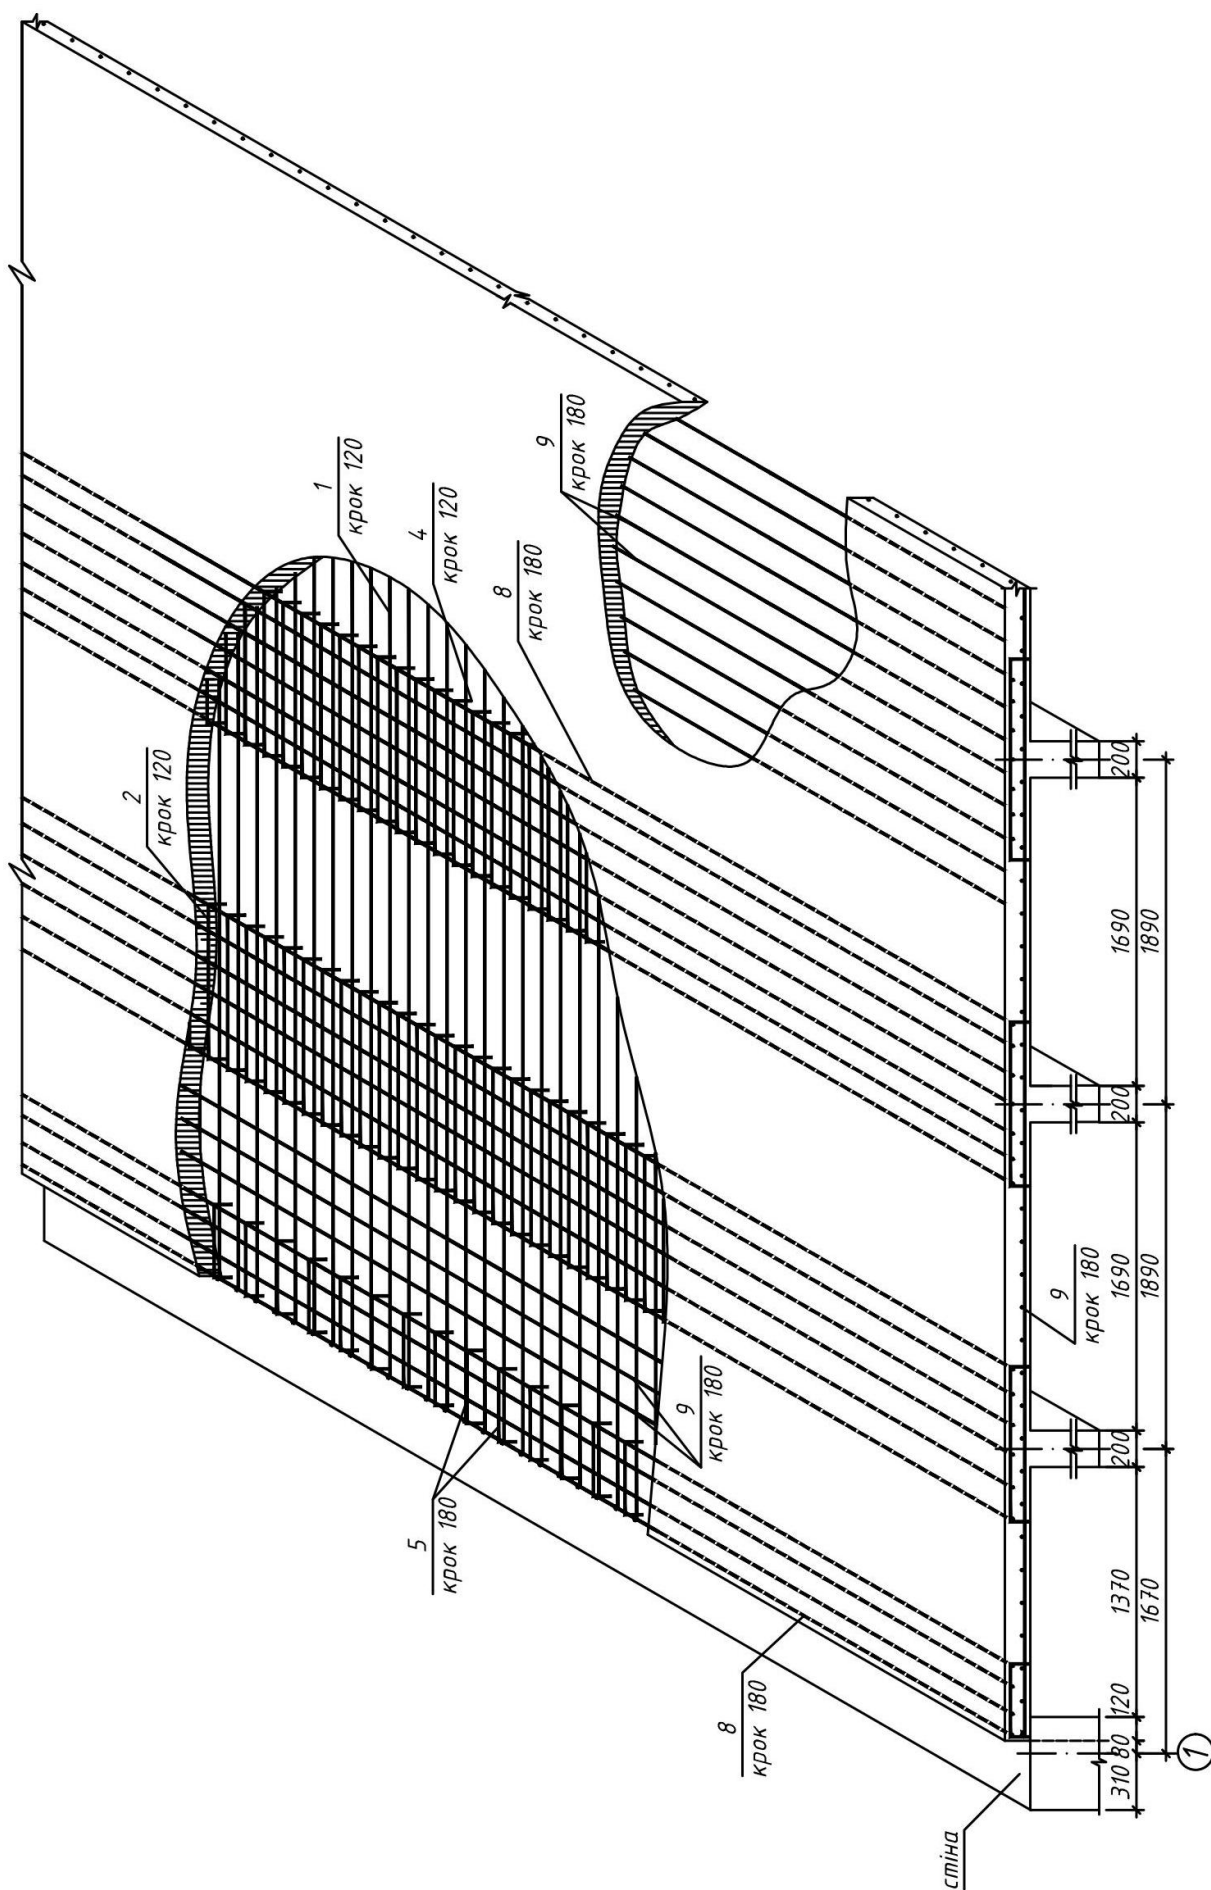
Схема розміщення арматури в плиті Пм-1
